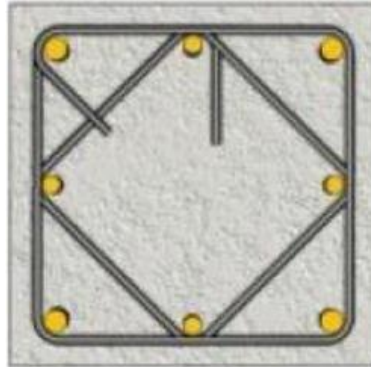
Disposition des armatures dans un poteau en béton armé [8]
